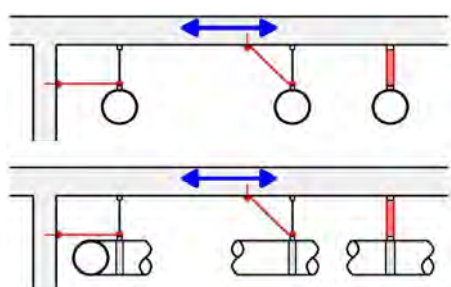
> Contreventement longitudinal et transversal de conduites
